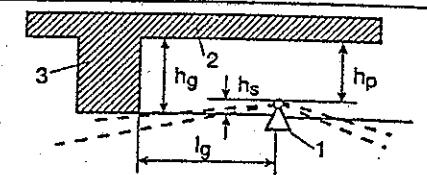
Distanțele de amplasare ale sprinklerelor față de planșee și grinzii:
